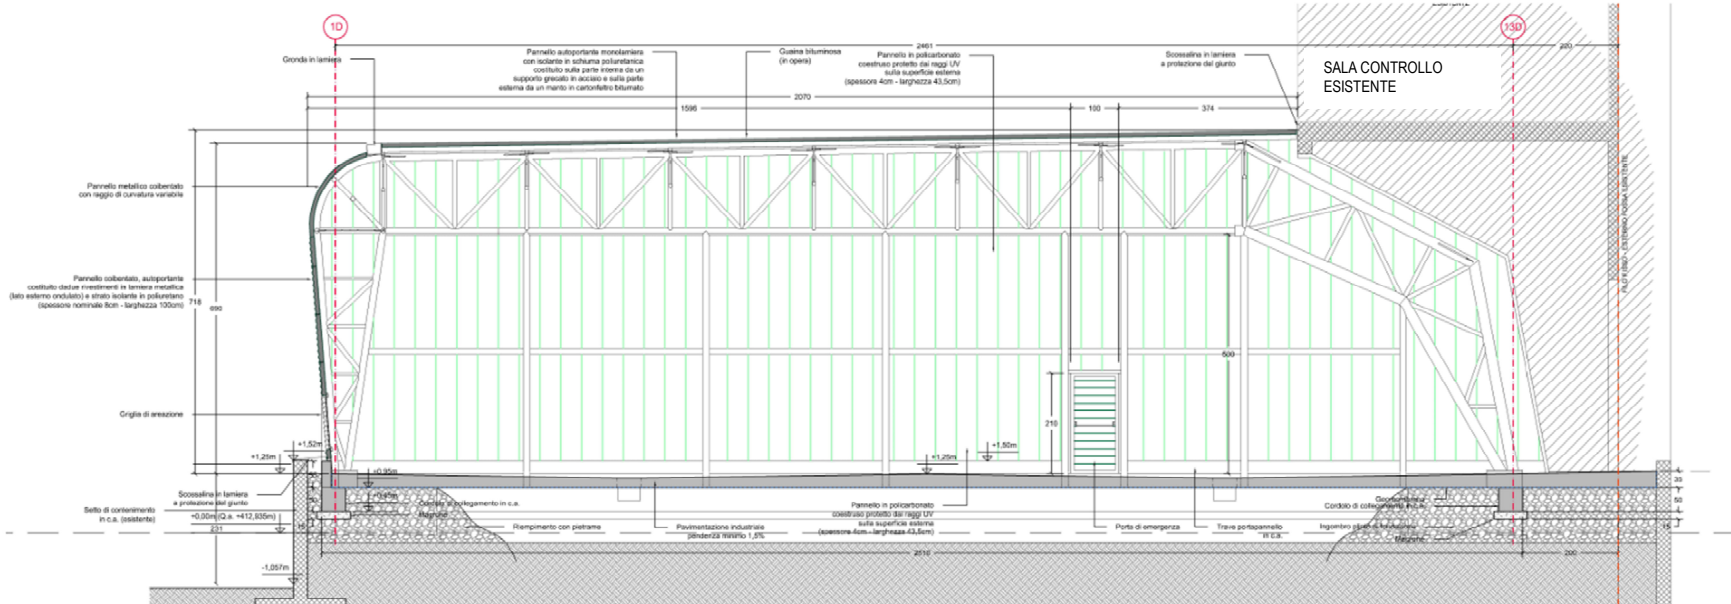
Sezione trasversale Edificio Avanfossa – stato di progetto
